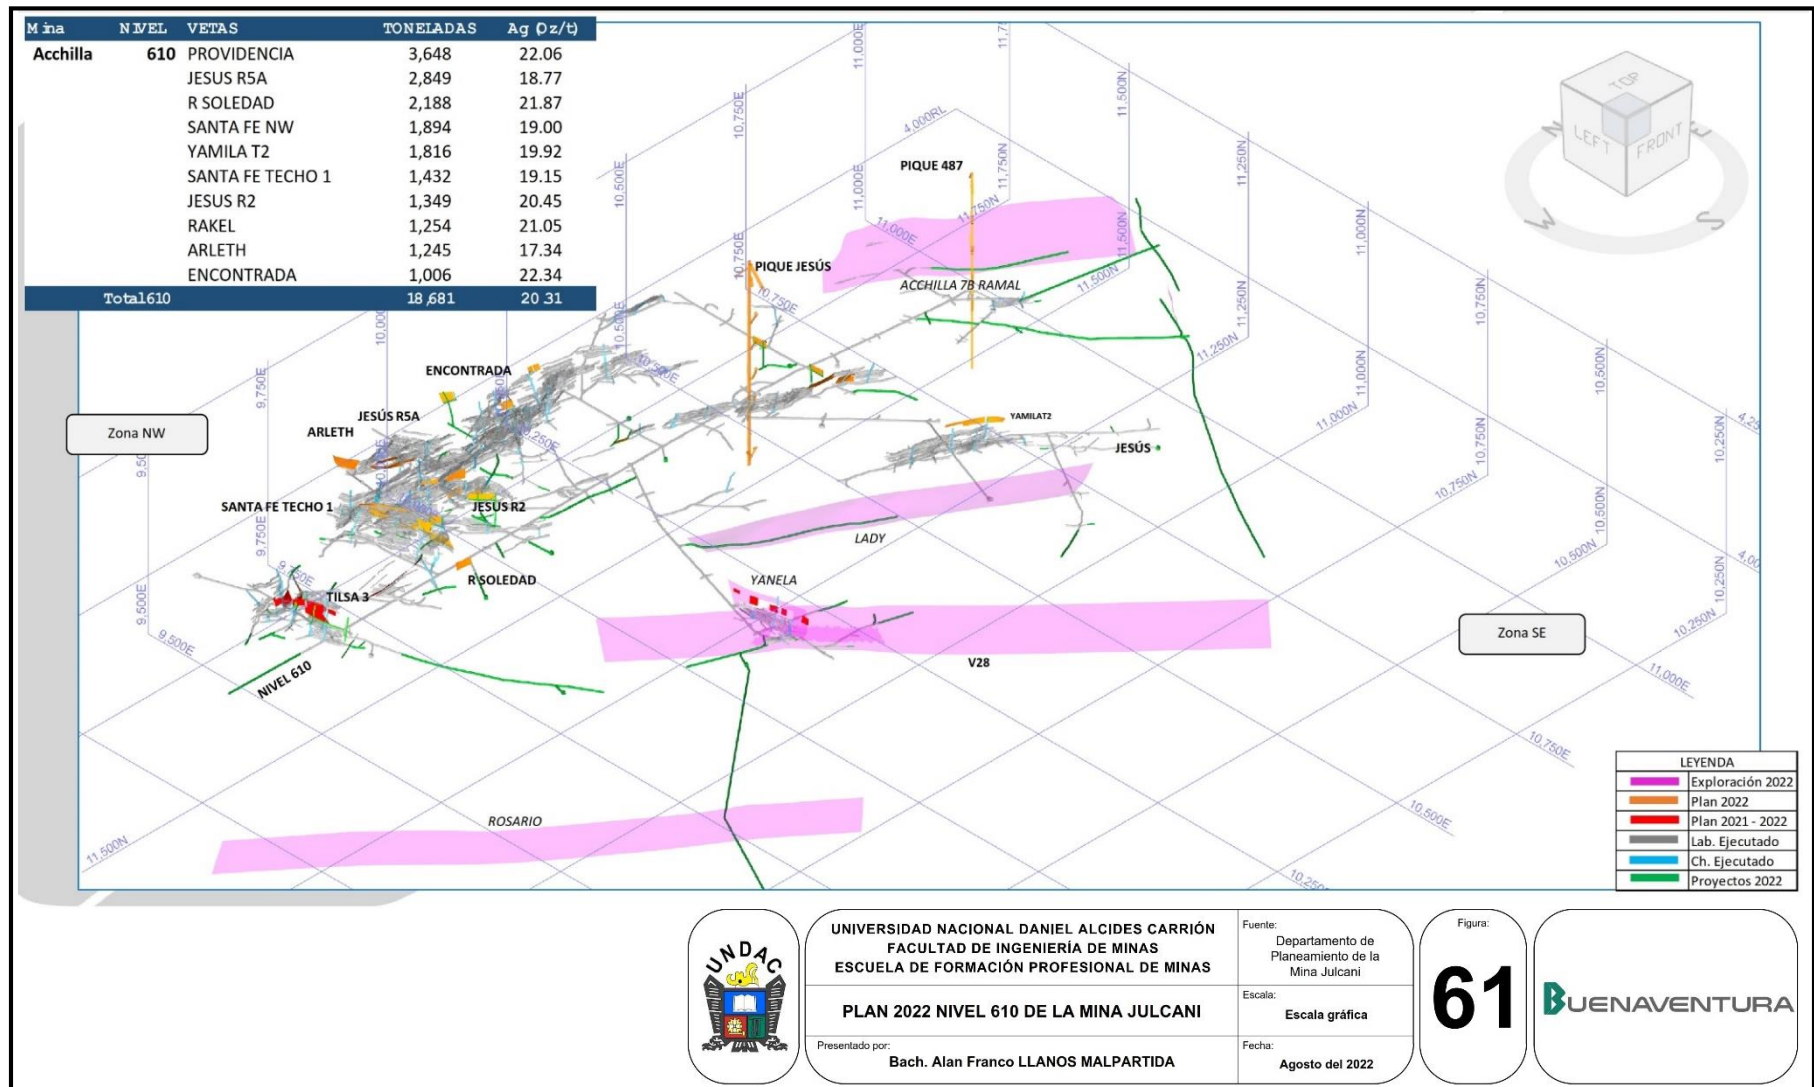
Plan 2022-Nivel 610 de la Mina Julcani.
